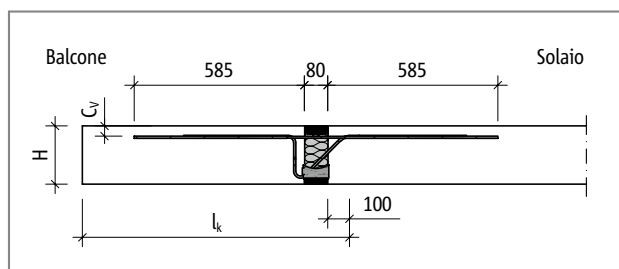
Schöck Isokorb® T tipo KL-M1 - M7: schema statico
